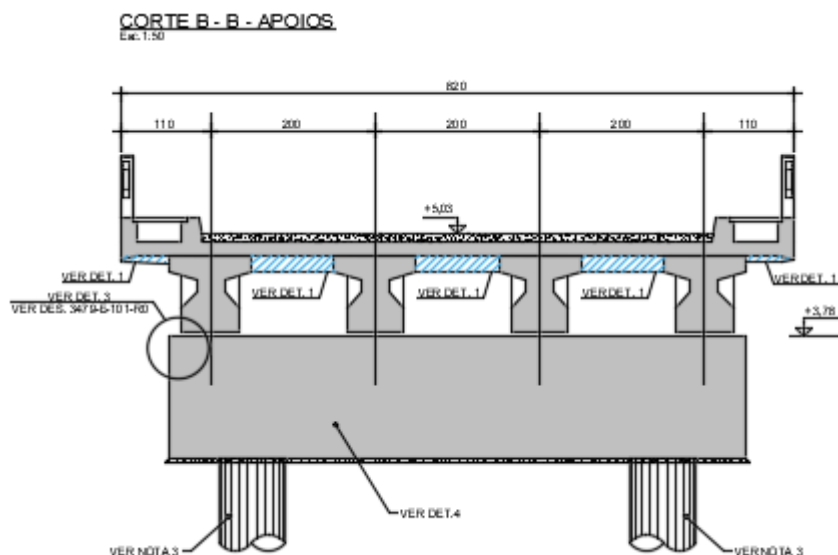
Seção do Tabuleiro – Ponte de Acesso – Lajes com armaduras expostas
